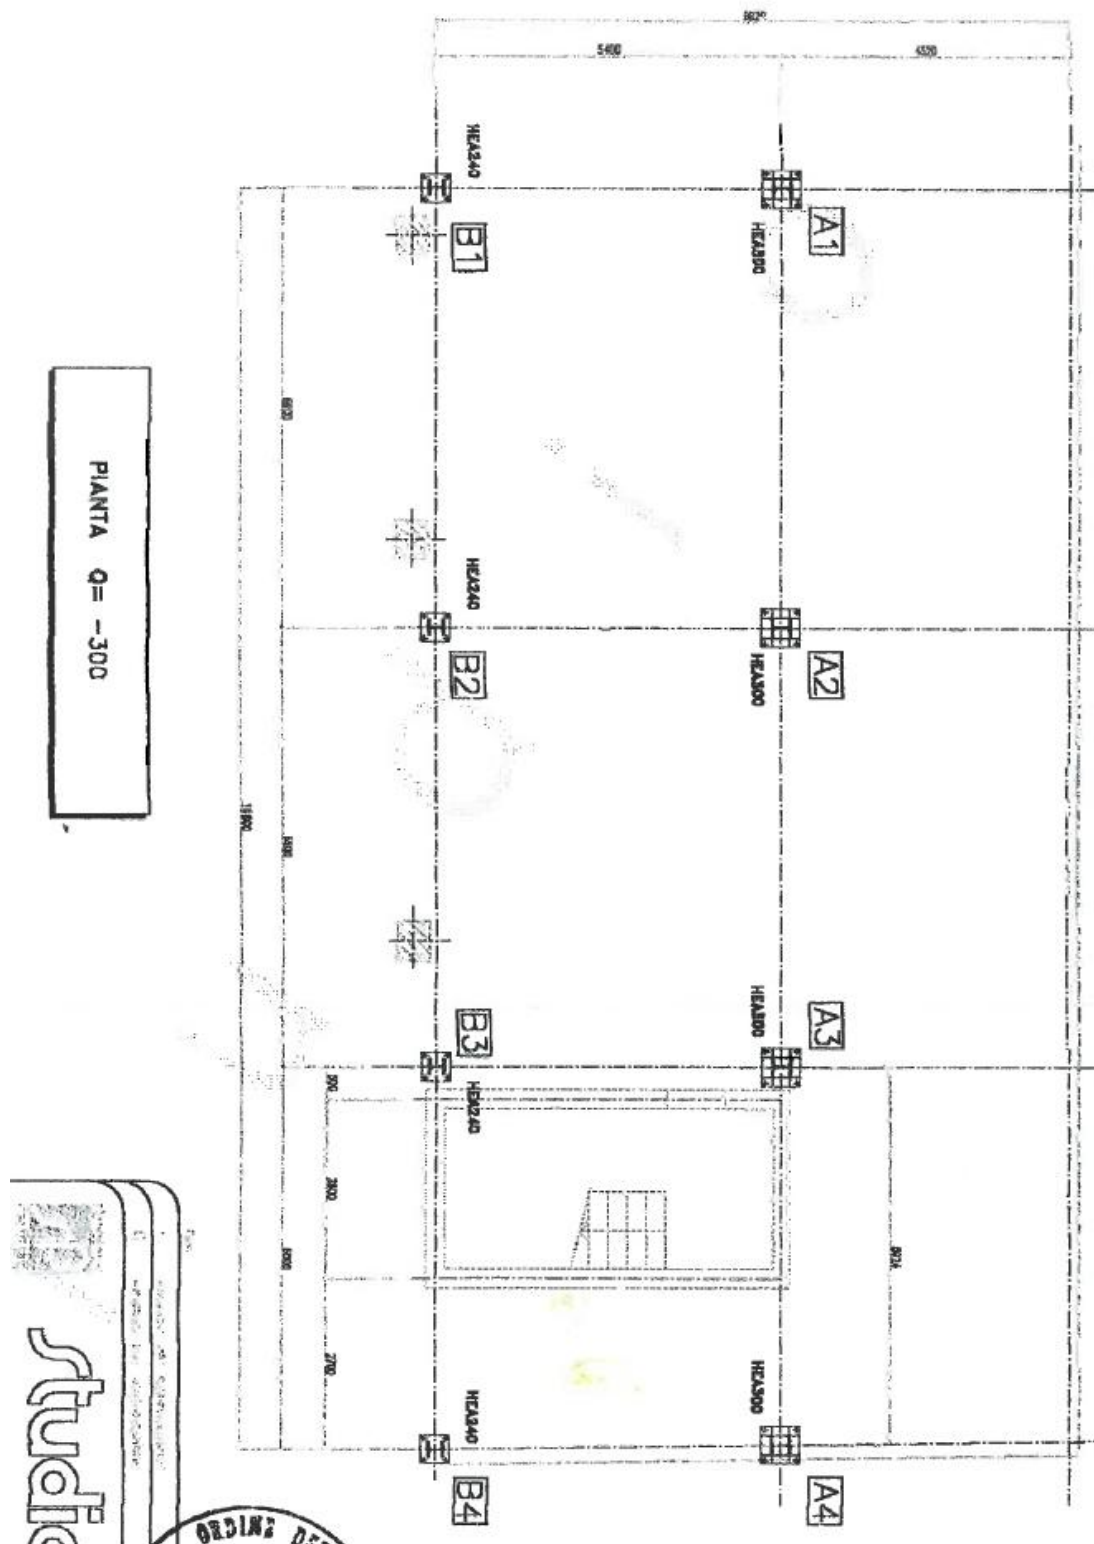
Particolare di A.2003.a.us.c.T12 - Piante generali - Pianta piano terra
